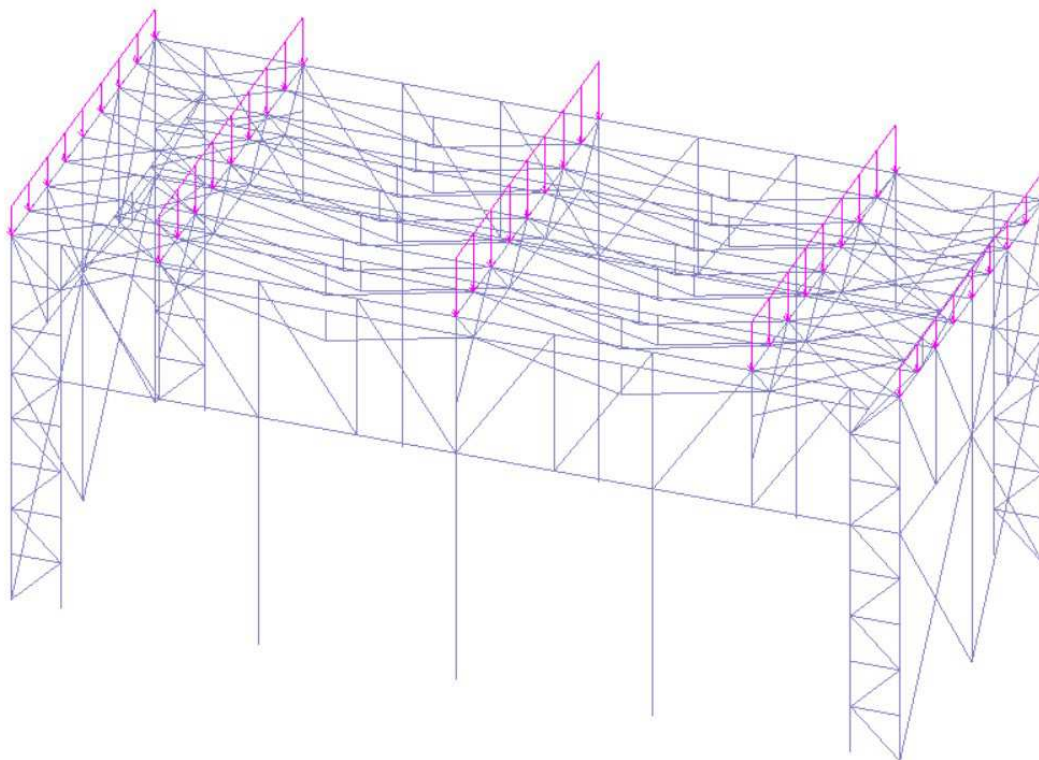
Постоянная нагрузка от веса покрытия
